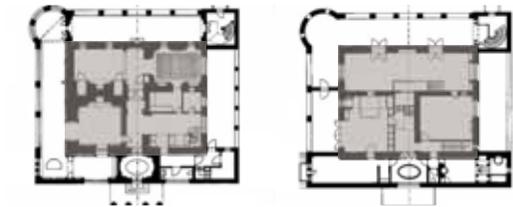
Villa Karma, Planta baja y primera, en gris la Villa original.
